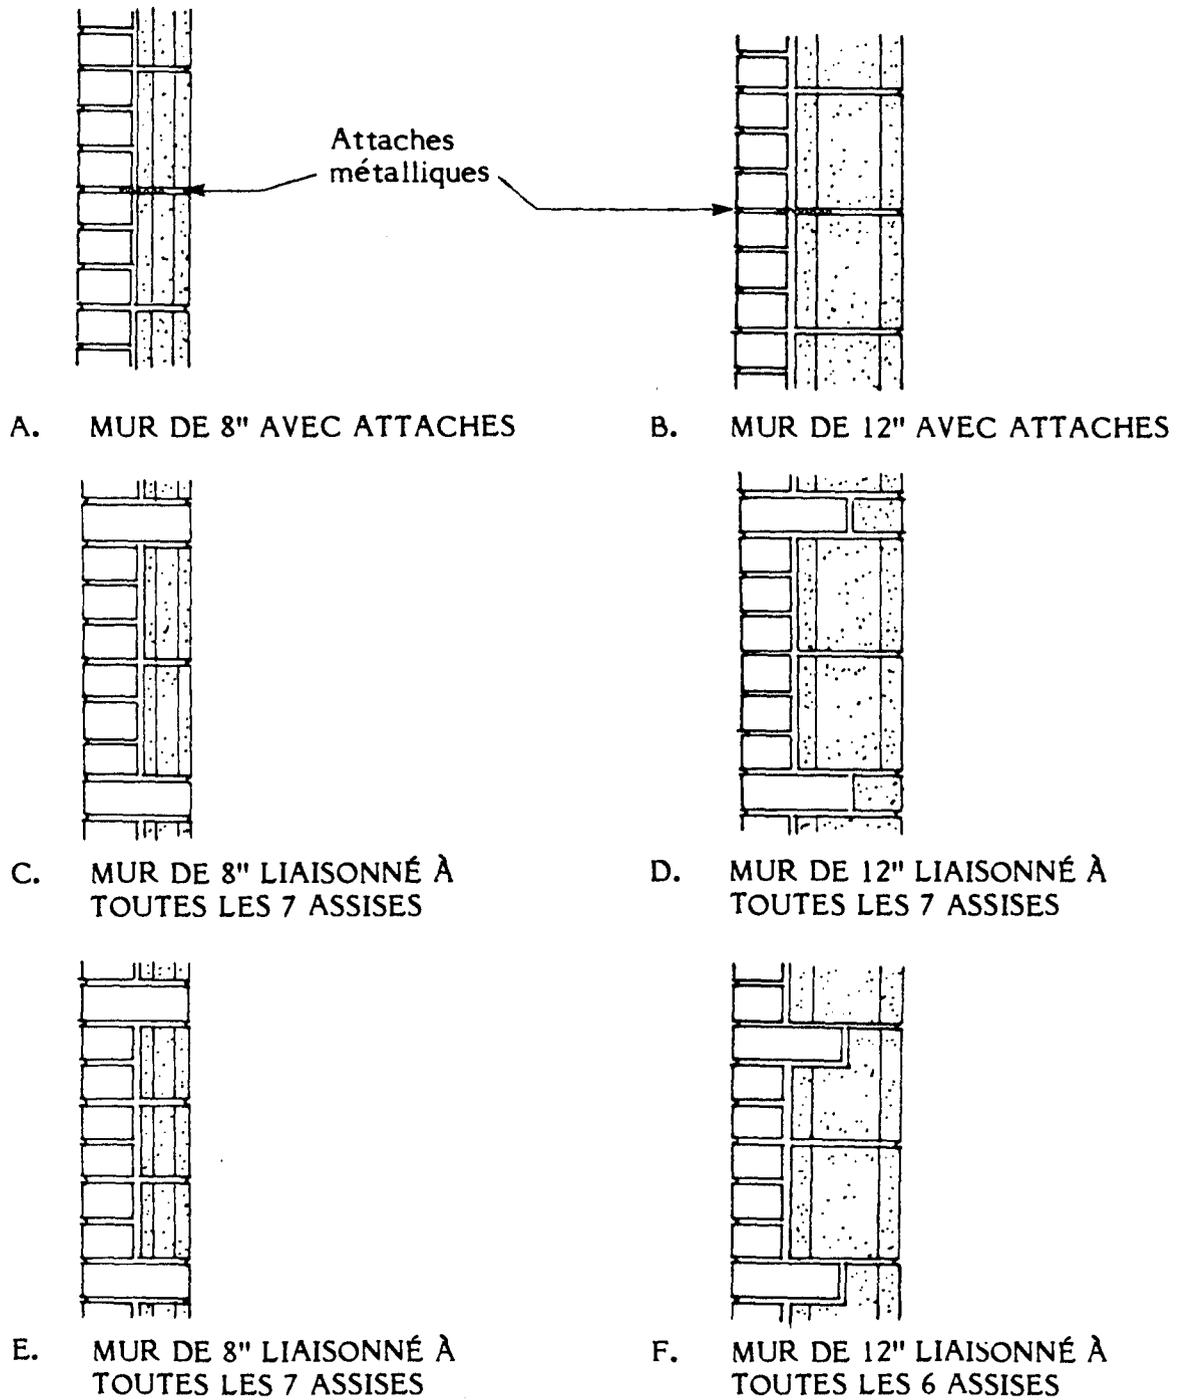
MURS DE BRIQUES ET BLOCS DE BÉTON - ÉPAISSEUR DE 8" et 12" AVEC DIVERS LIAISONNEMENTS
